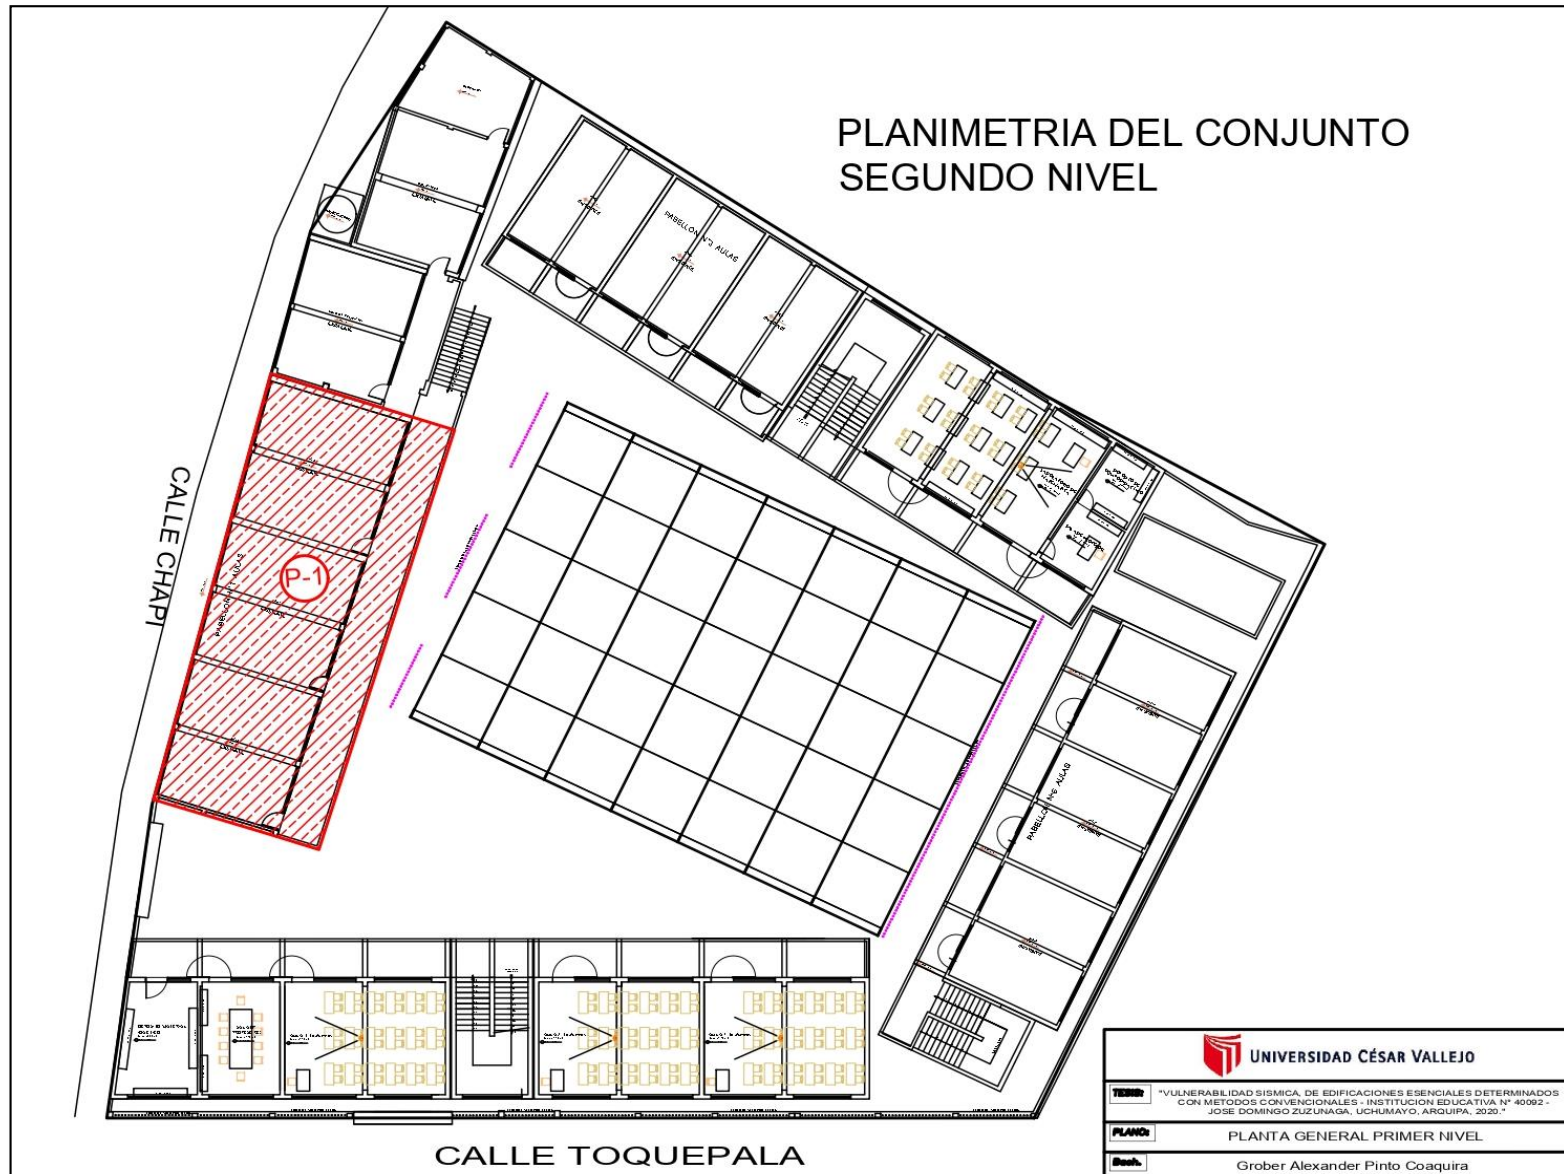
Plano general de la Institución Educativa existente con el pabellón a intervenir P-1
